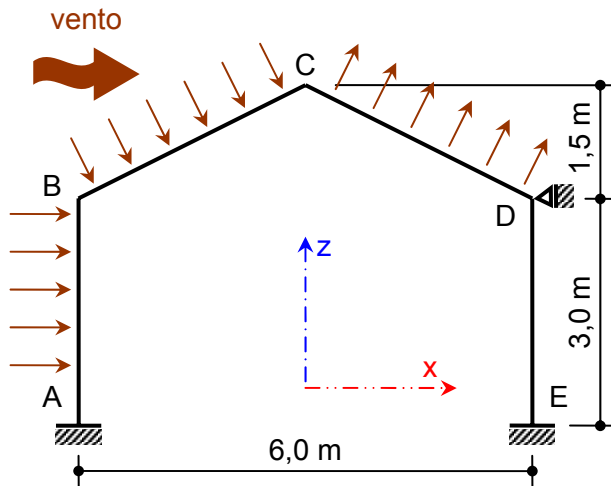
Esquema estrutural do pórtico sob ação do vento
